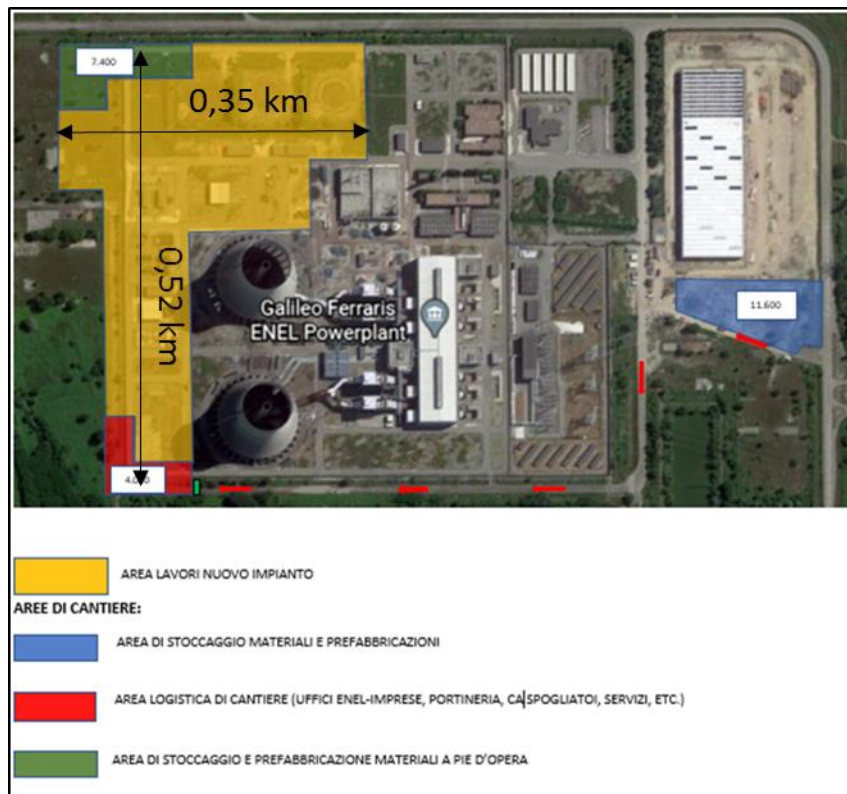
Aree interessate dal Progetto nuova unità a gas
